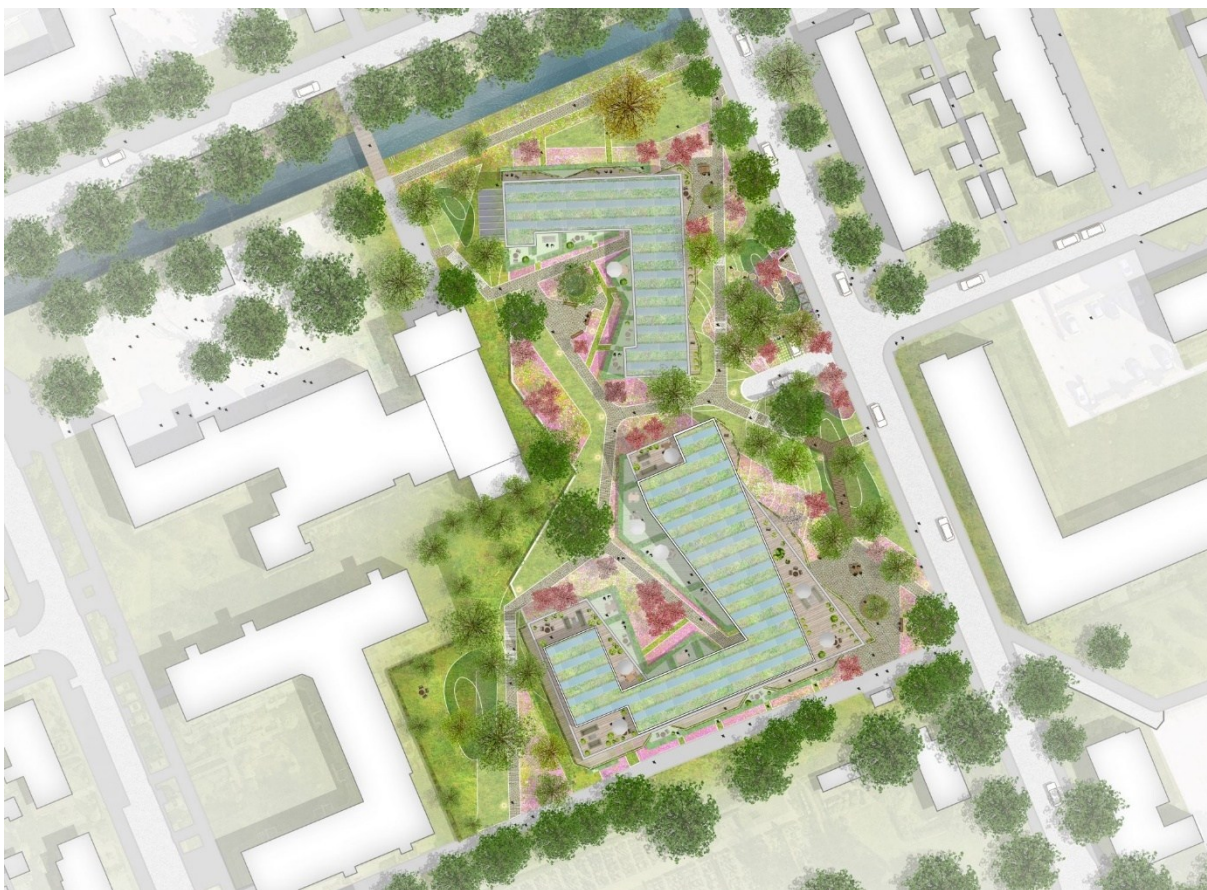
Overgenomen uit Casa Vita, Pijnacker (Blauwhoed, z.d.).
